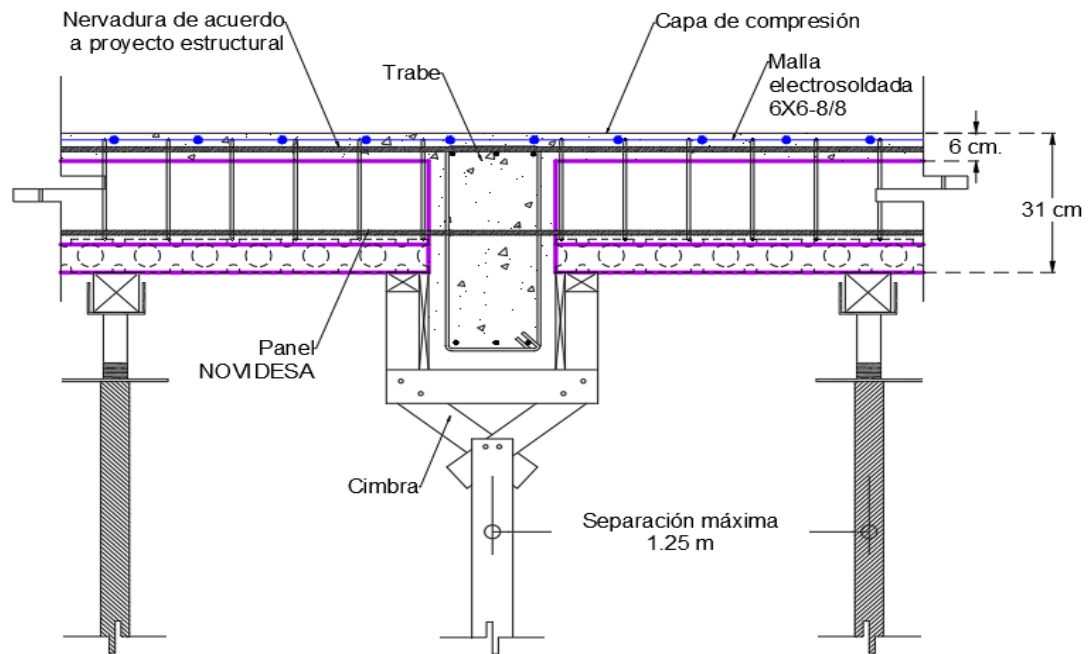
Detalle en corte longitudinal del sistema de entrepiso con panel de poliestireno. (Área Técnica Novidesa, 2010)
